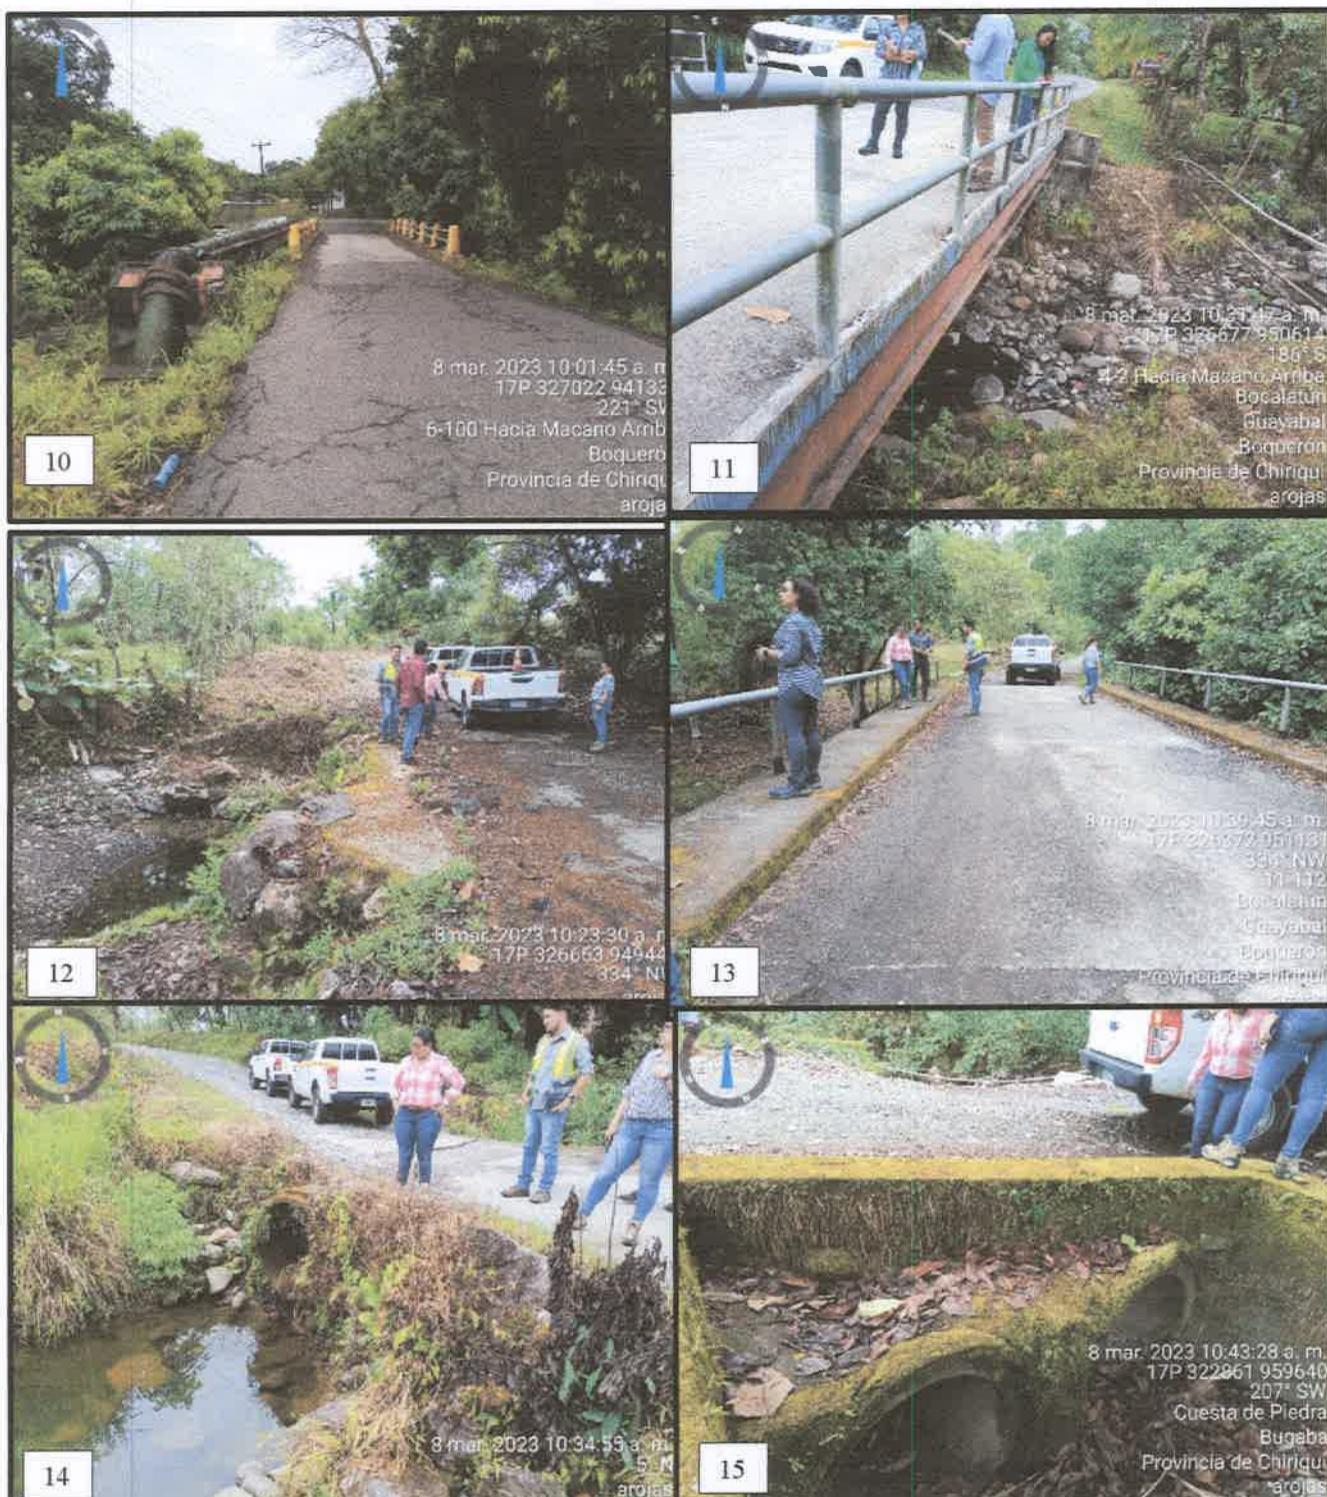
Construcción de punto sobre río Caimito (no se tocará la estructura y tubería del IDAAN)
